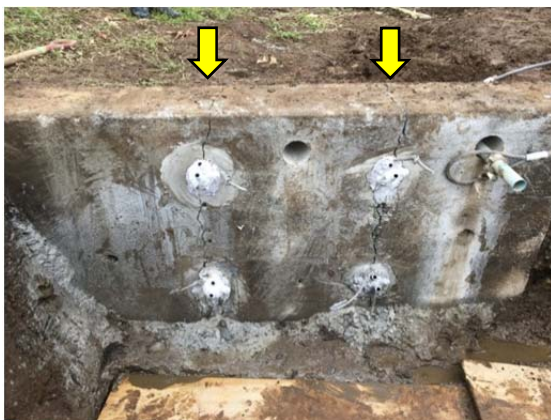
凍結膨張による縦方向のひび割れ発生状況
